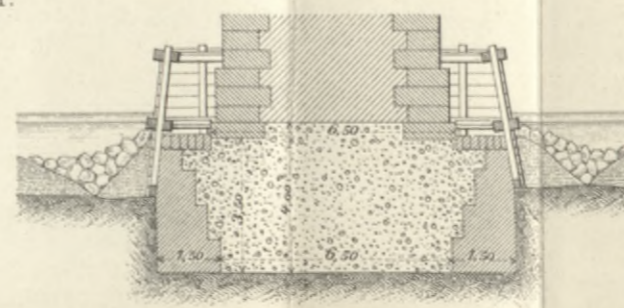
Hölzerner Mantel f.d. Pfeilergründung einer Brücke der Bahn v. Lorient n. Brest. M. 1:250.
